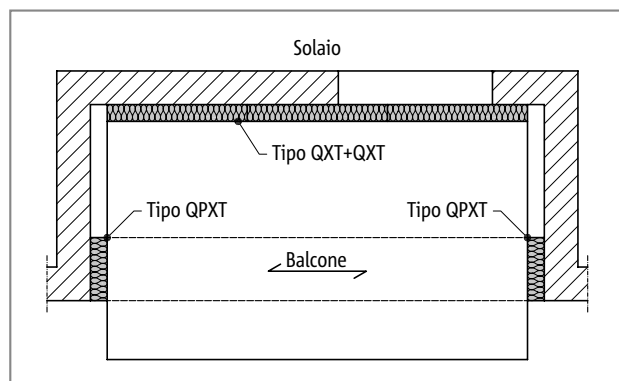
Schöck Isokorb® tipo QXT+QXT, QPXT: loggia appoggiata su tre lati con tirante
